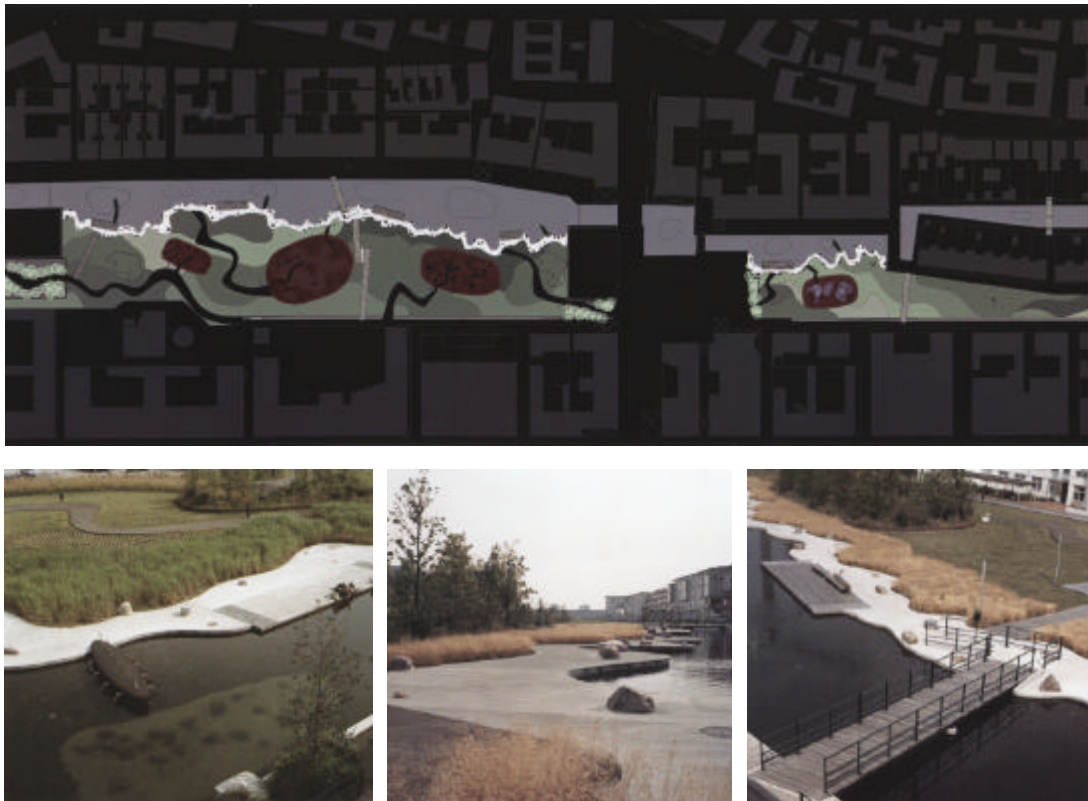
, 8, 9, 10: L'Anchor Park a Malmo. Planimetria e immagini del parco.
